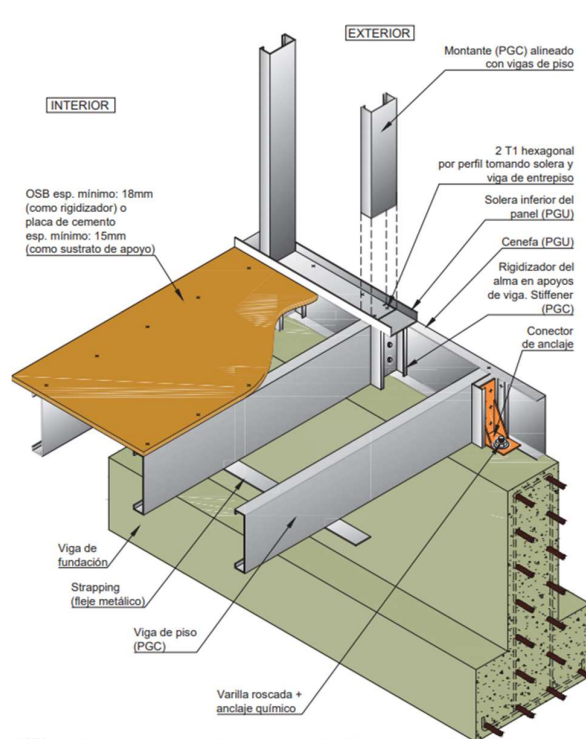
| Detalle fundación (en esta obra la base de la viga de fundación son zapatas aisladas cuadradas ubicadas cada cierta distancia entre ellas). Fuente: www.incose.org.ar
